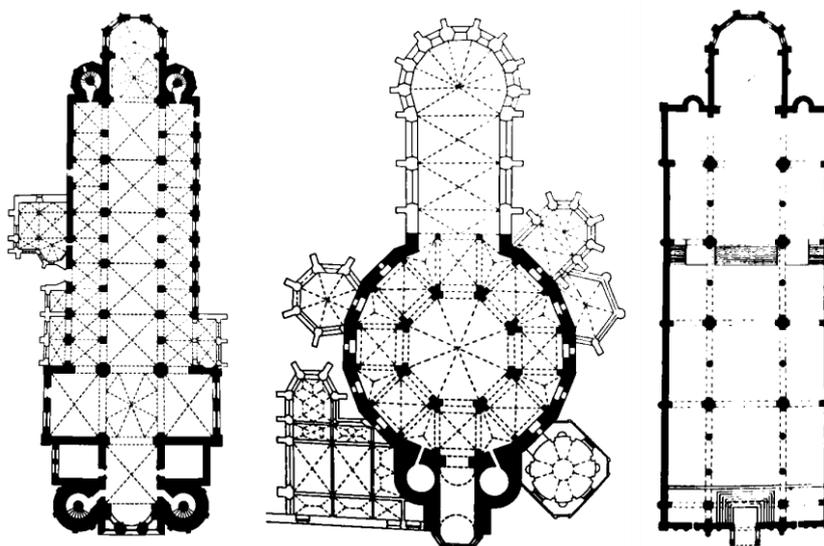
(à esquerda): Catedral de Worms, 1200, Planta baixa.
